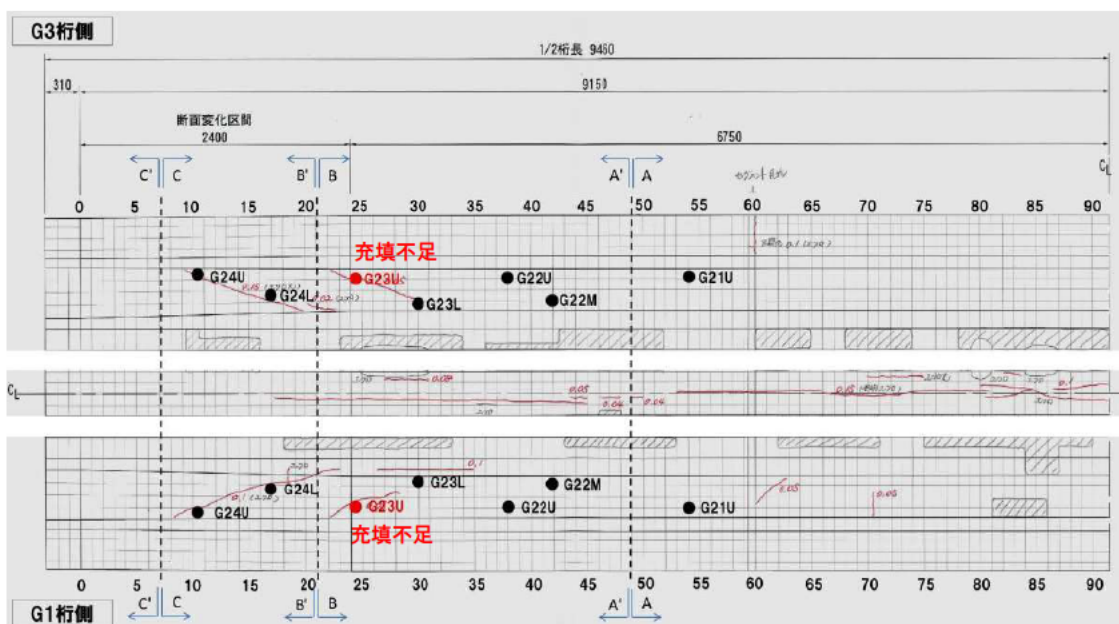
シース沿いひび割れとグラウト充填状況 (G2 桁)
